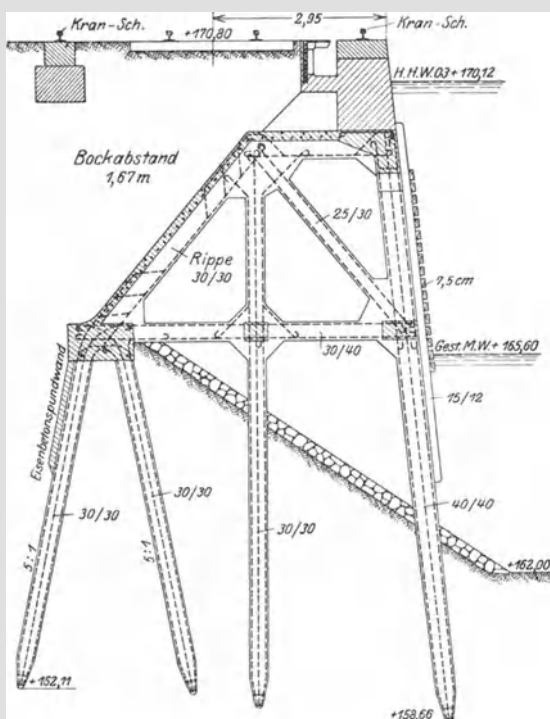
Ufermauer Cosel, aufgelöst in Eisenbeton. Maßstab 1:130.
